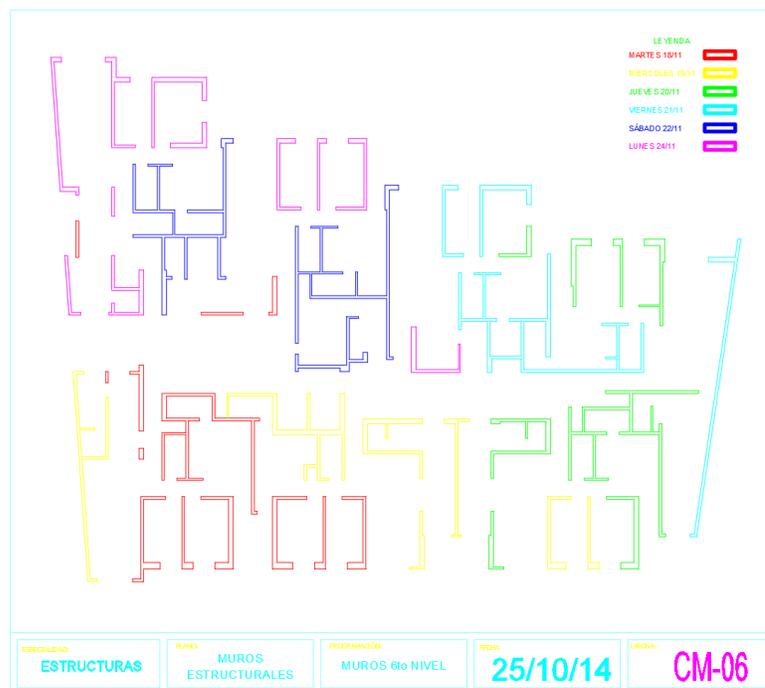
Sectorización de Muros Nivel 6. Fuente: Elaboración Propia
